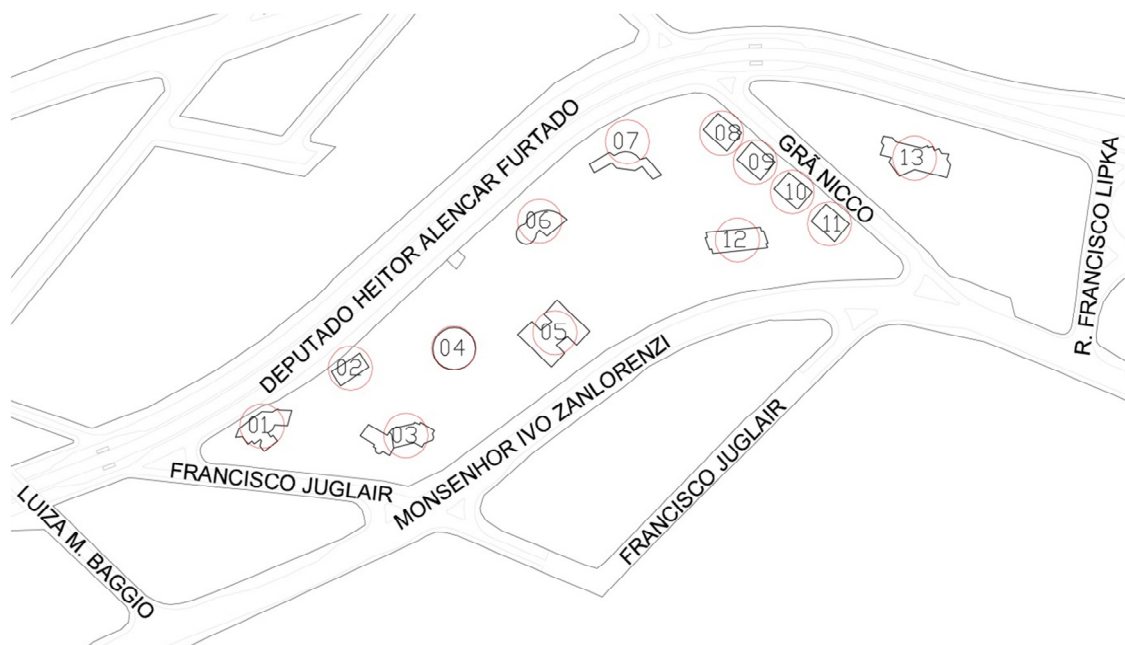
ÁREA III – MOSSUNGUÊ – PLANTA DOS EDIFÍCIOS NUMERADOS
